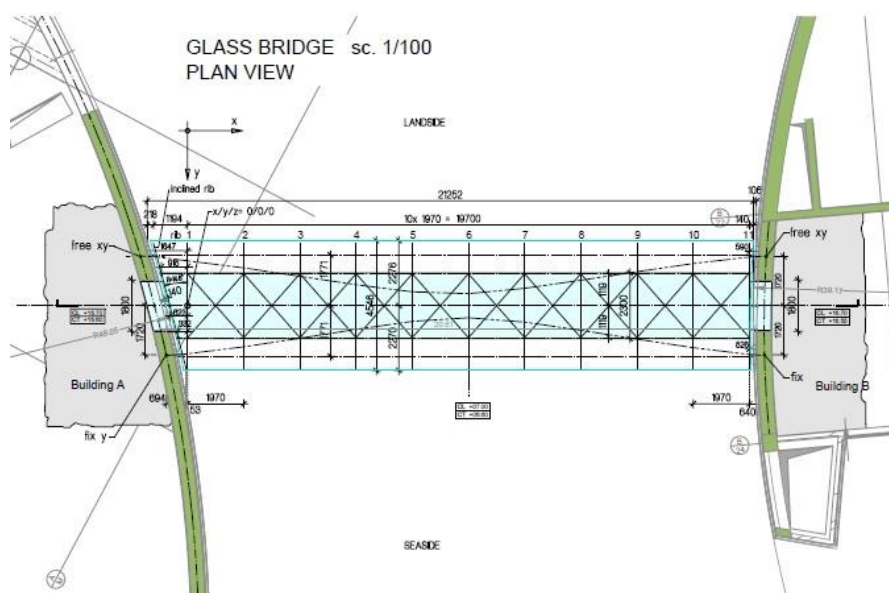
Representação em planta do projeto da Ponte Pedonal da Fundação Champalimaud [24]
